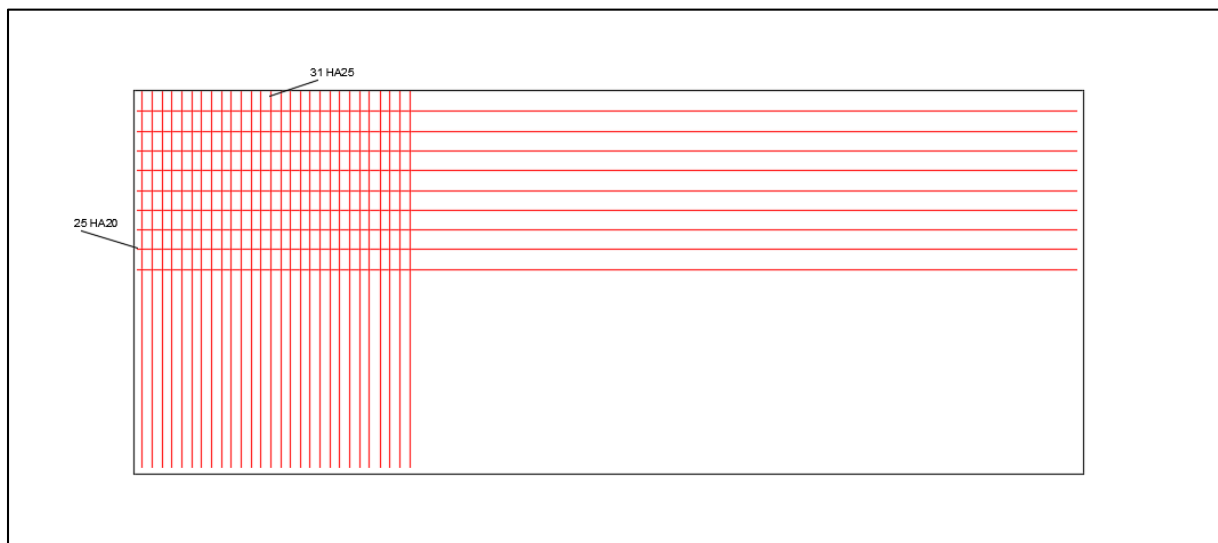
Ferrailage de la semelle (nappe supérieure)
